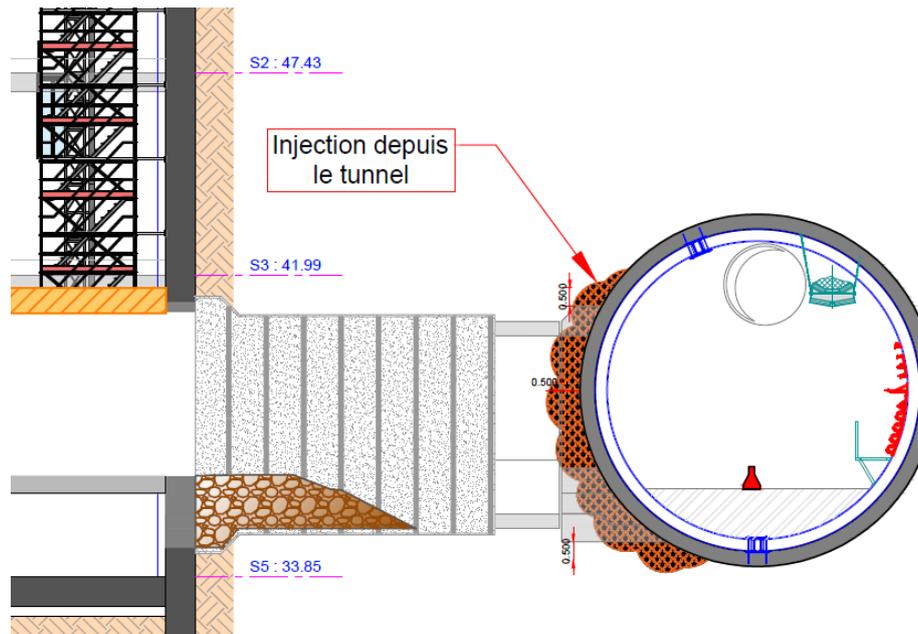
Réalisation d'une auréole de traitement d'1m au droit du rameau depuis le tunnel
